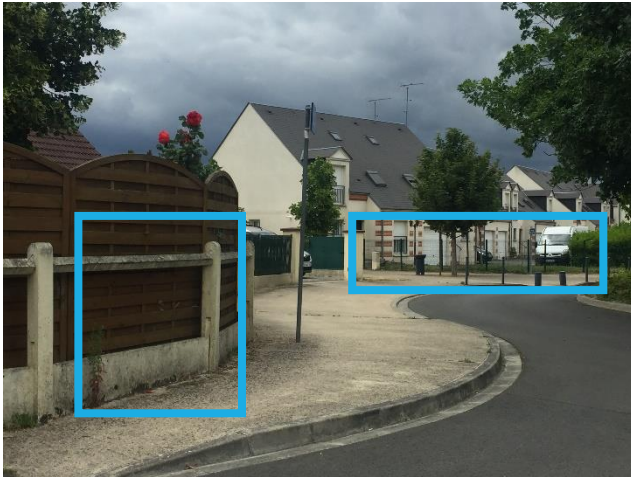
maison à Saint-Denis en Val, zone d'aléa très forte, on observe au premier plan une clôture en ciment avec un muré bas, en second plan dans les constructions plus récentes on peut apercevoir une clôture grillagée, Pauline DEVAUX
